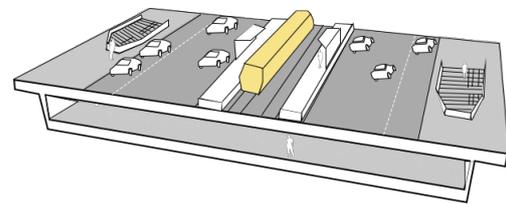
Wasenstraße Bestand (Eigene Darstellung)
